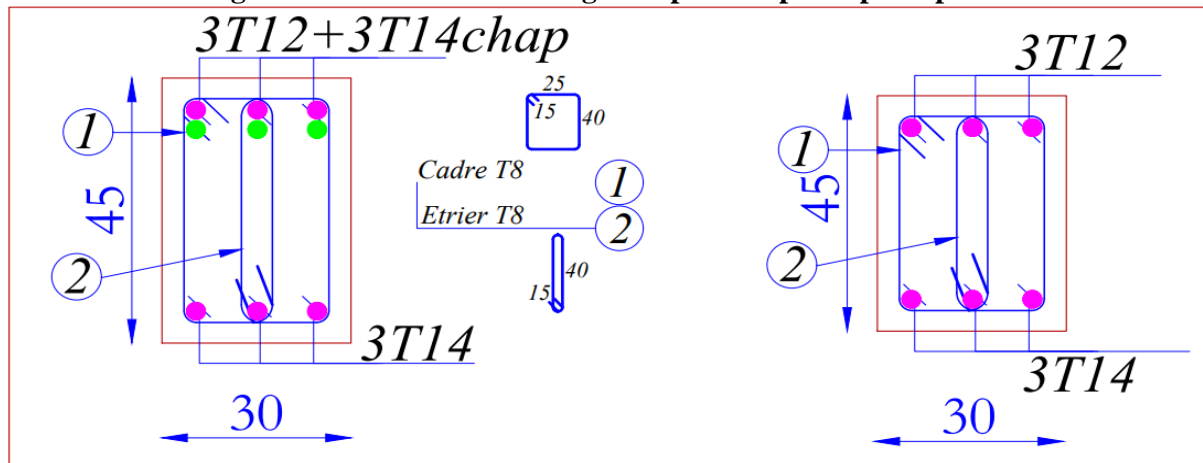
schéma de ferrailage des poutres secondaires porteuses.
